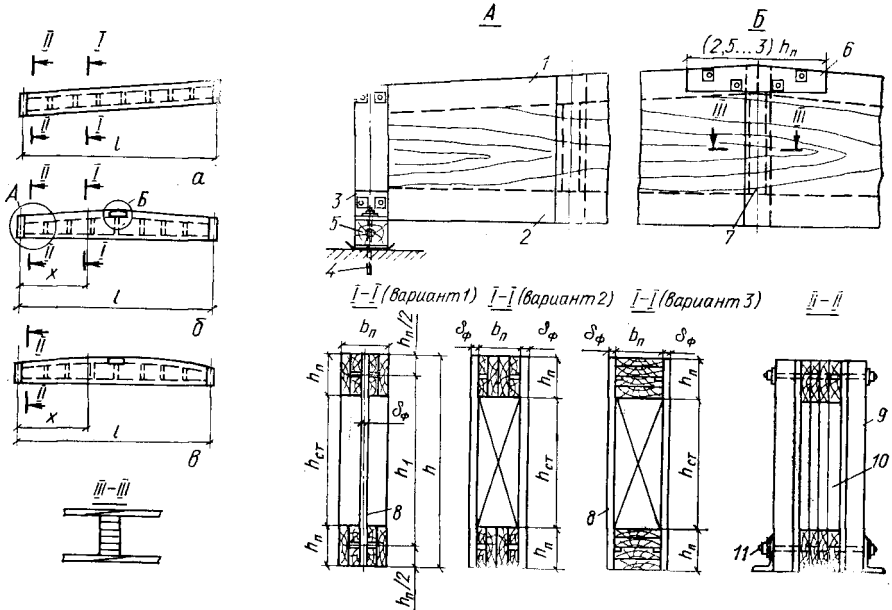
Фанерные клееные балки с плоской стенкой:
